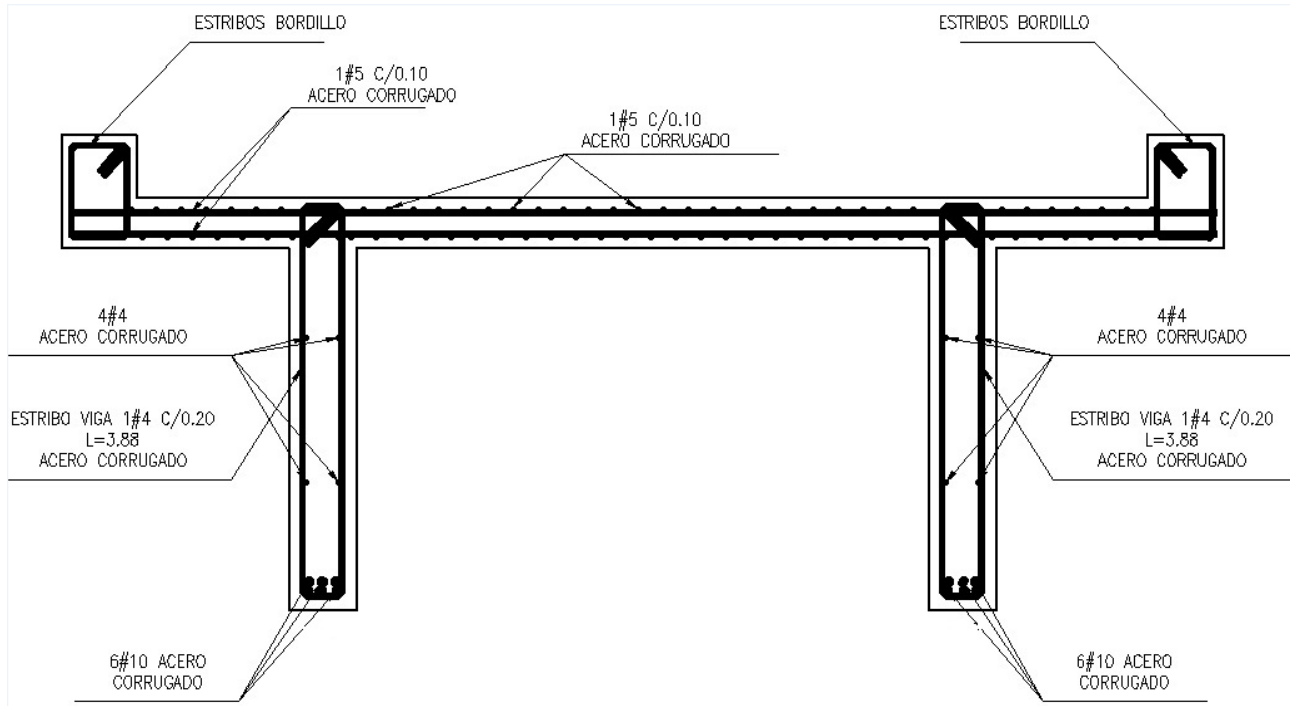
Resultados del ensayo de escáner en losa y vigas de la súper estructura
